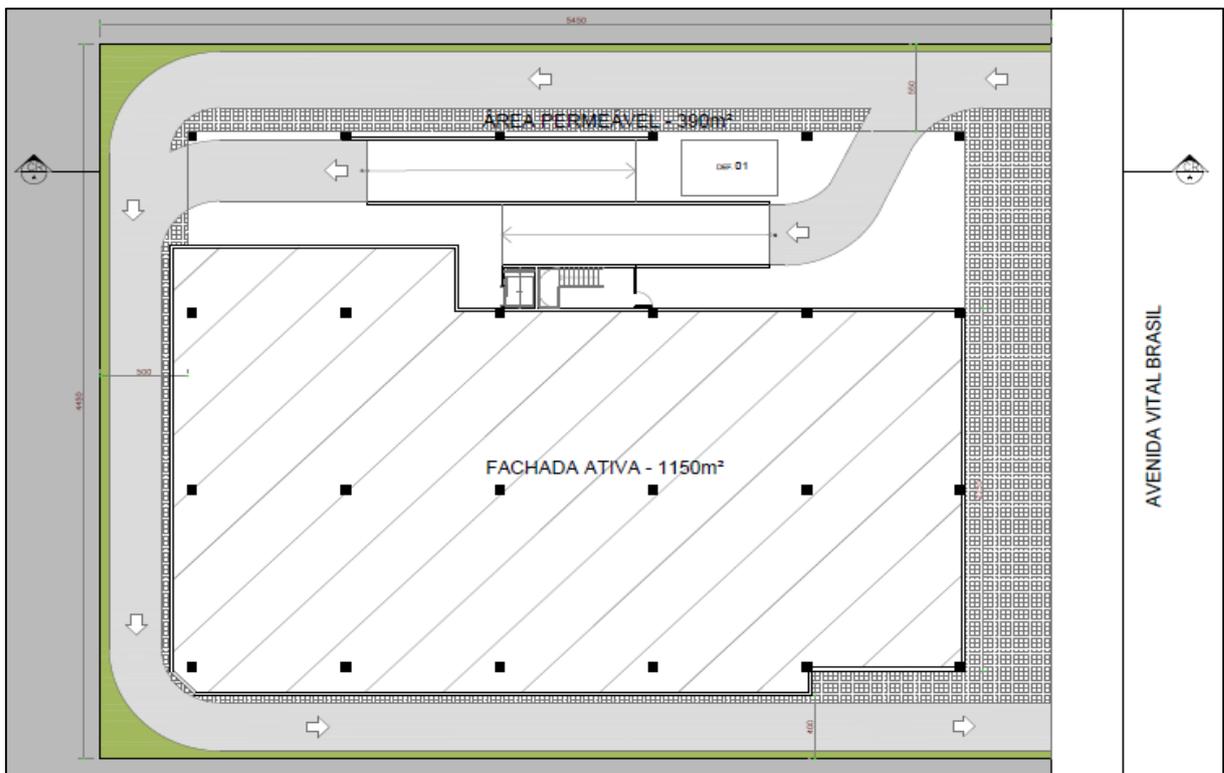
Planta do pavimento térreo, considerando área mínima permeável de 15% e área destinada a fachada ativa de 50%.
